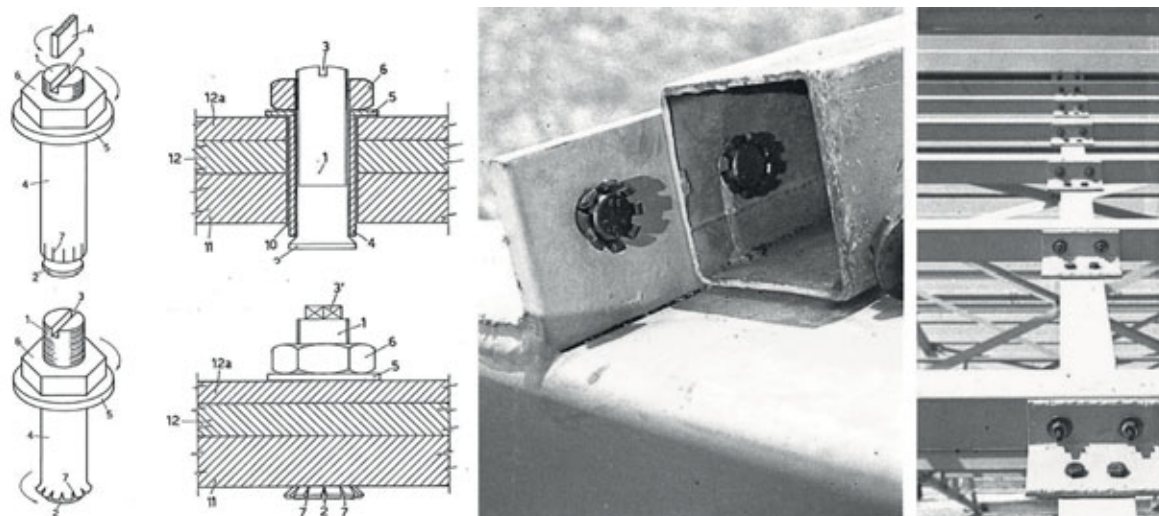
Seconda fase operativa del Centro Carpenteria Dalmine (1968-1976): la proposta del «bullone a espansione per unire elementi strutturali a corpi cavi» (Fondazione Dalmine).
